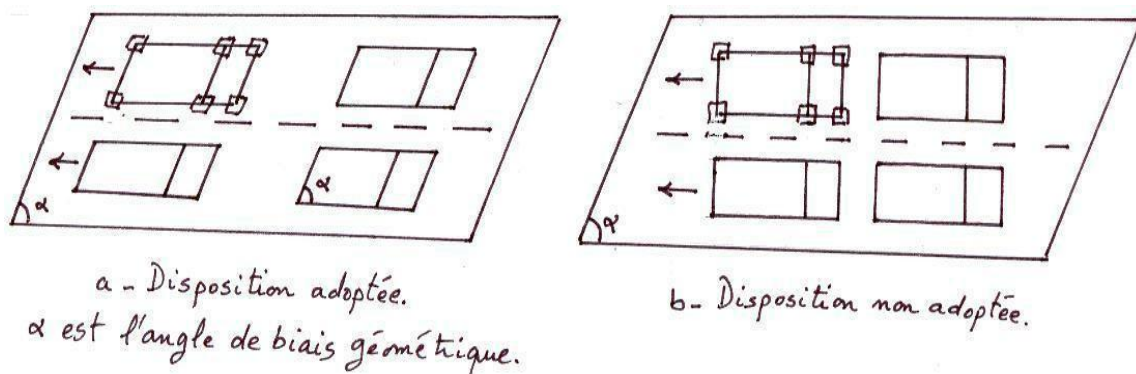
Disposition en plan du système Bc dans un pont biais.
